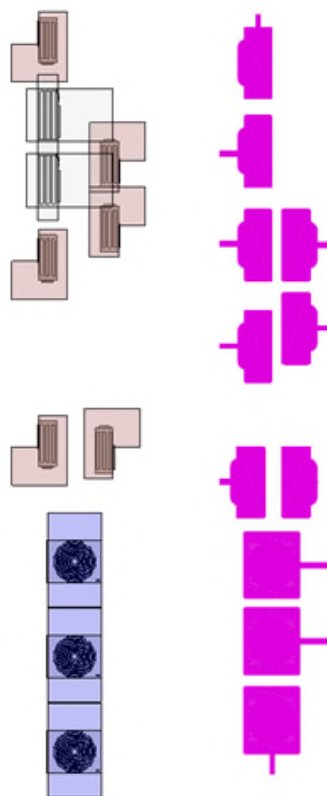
Equipos climatización exteriores. Izda: Modelo Revit. Dcha: Planos As-built
